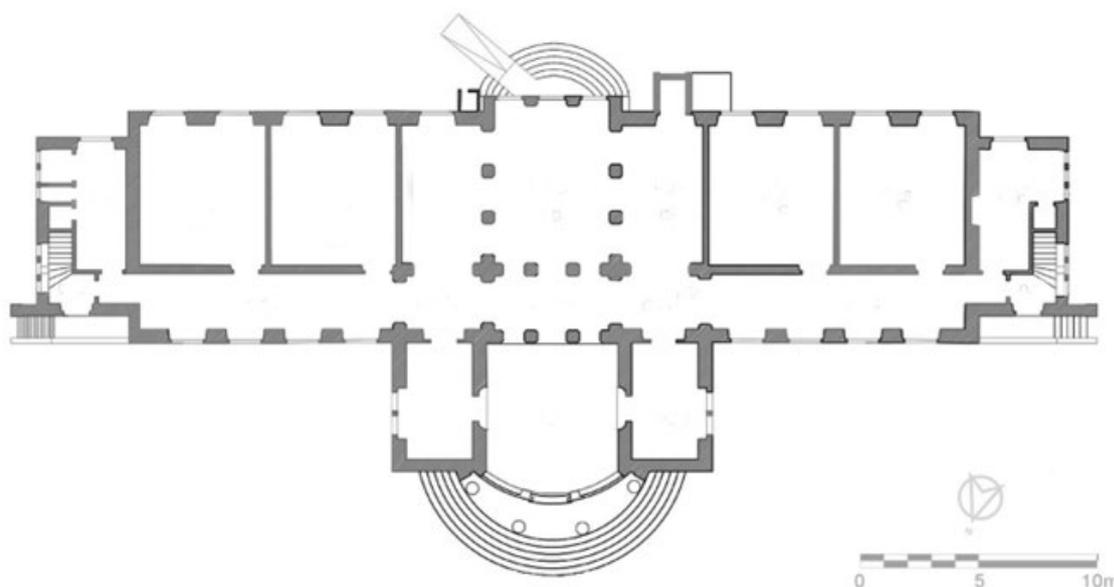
Planta Original do Piso 0 Fonte: (n.d.) Médio Tejo
